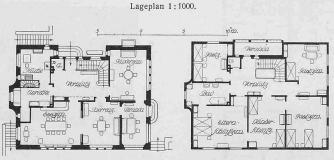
und 3. Grundrisse des Hauses Wirth in Dietfurt. - 1; 400,
